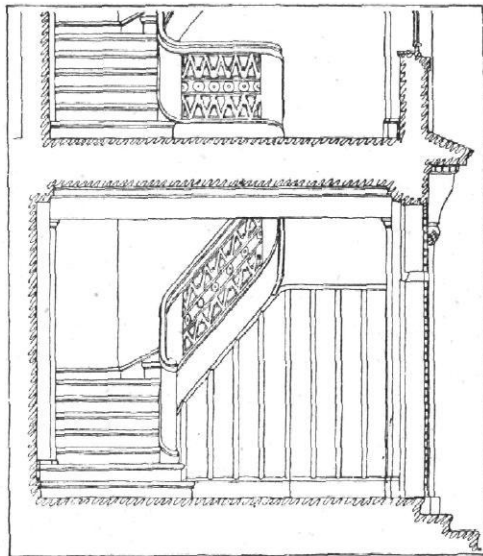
und 23 / Treppe (Grundriß und Schnitt) im Hause des rechten Blocks, Pontwall I
